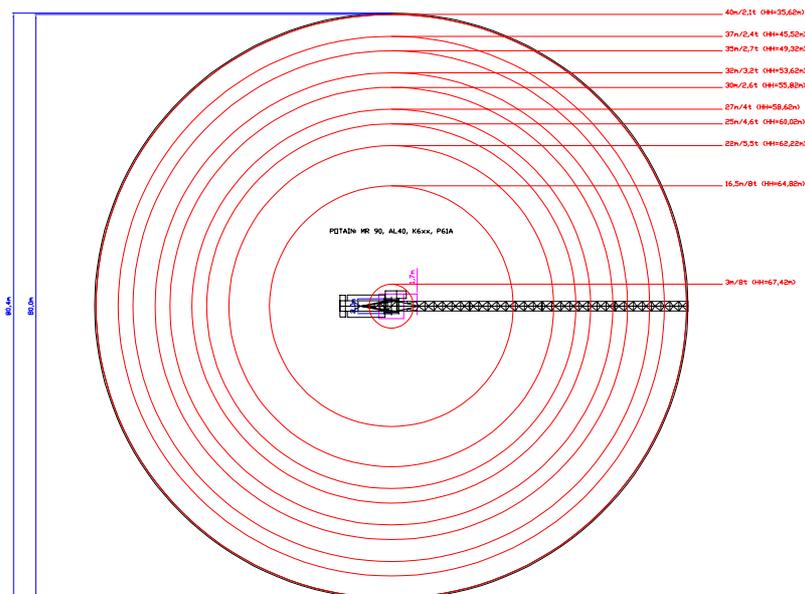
Oben drehender Wippausleger in der Draufsicht
